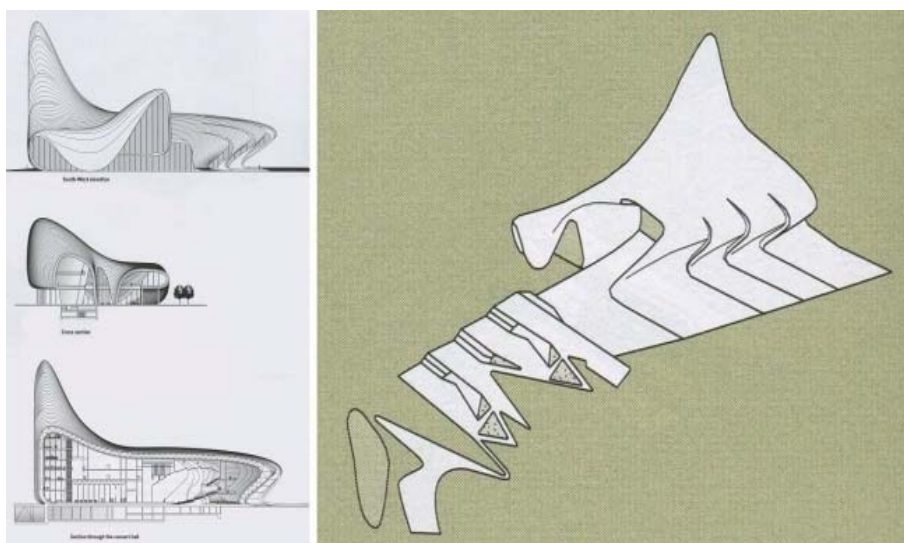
Фасады здания и развёртка проекта Захи Хадид
